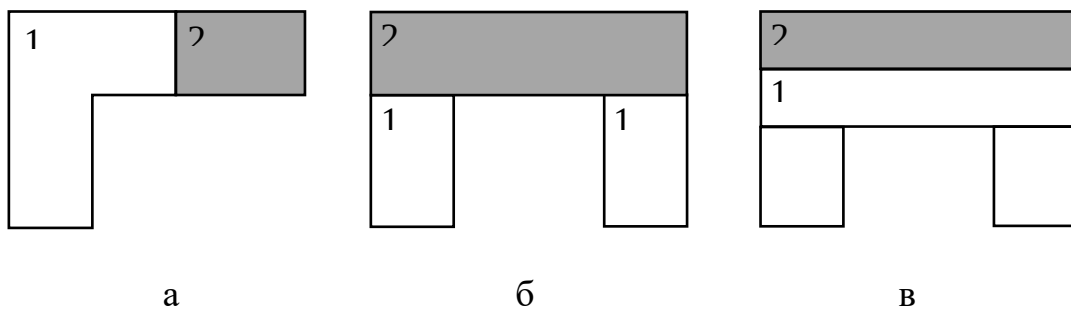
Схеми прибудов та вбудов до будівель : а – прибудова корпусу в торець існуючої будівлі; б – об'єднання прибудовою та вбудовою двох корпусів; в – збільшення шири існуючого корпусу прибудовою; 1 – комплекс будівель; 2- прибудова або вбудова
